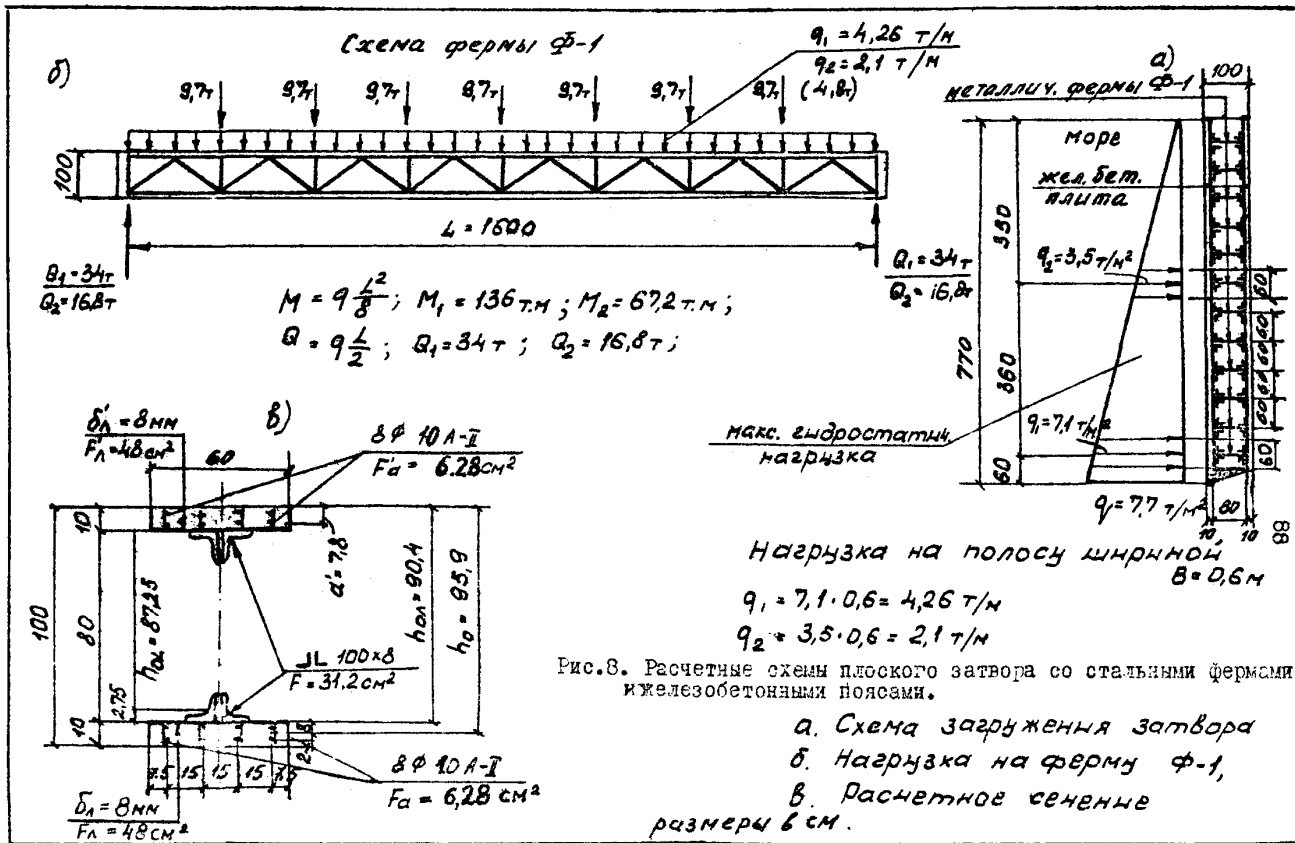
Расчетные схемы плоского затвора со стальными фермами и железобетонными поясами.
